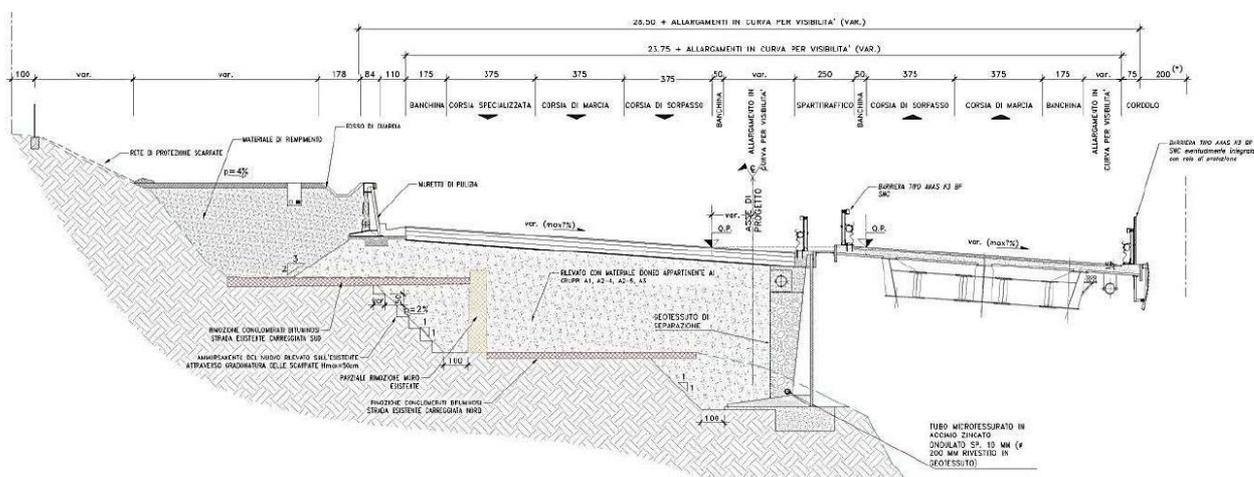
Sezione tipo B con una carreggiata in viadotto
